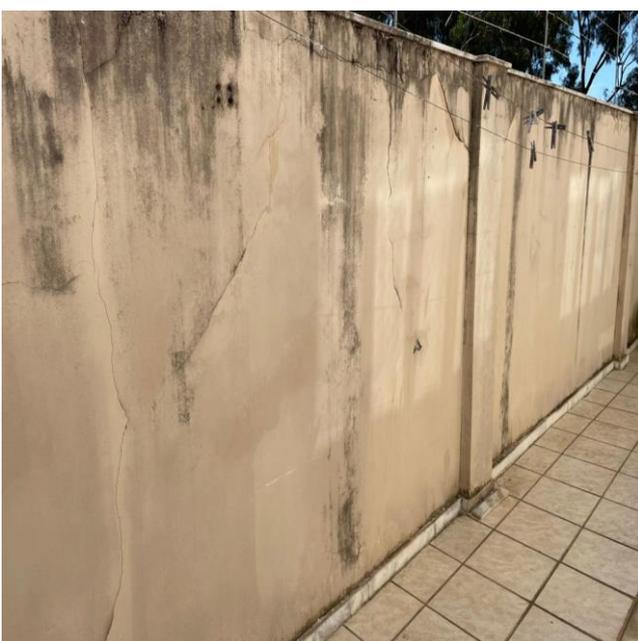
Apartamento 102 e do bloco A - trincas no muro.
